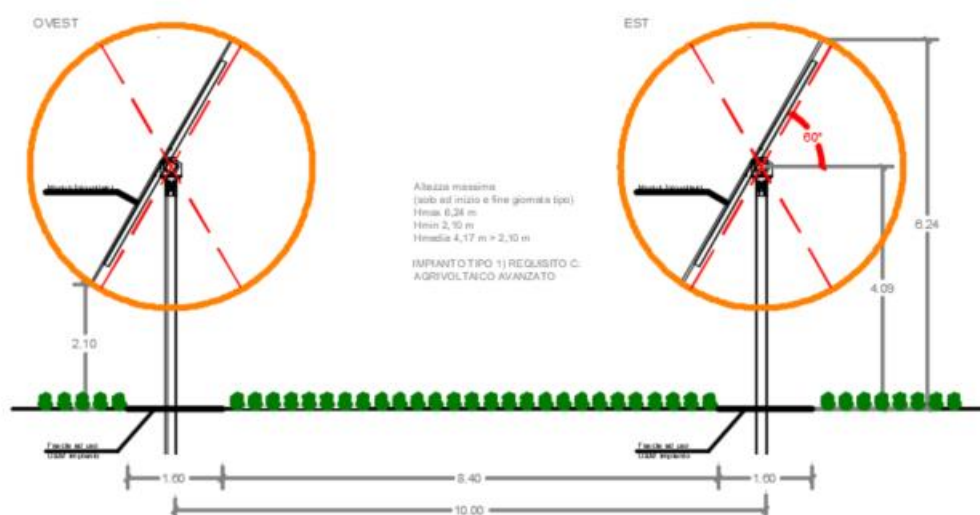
Sezione tipo Struttura tracker e mutue distanze tra le strutture
